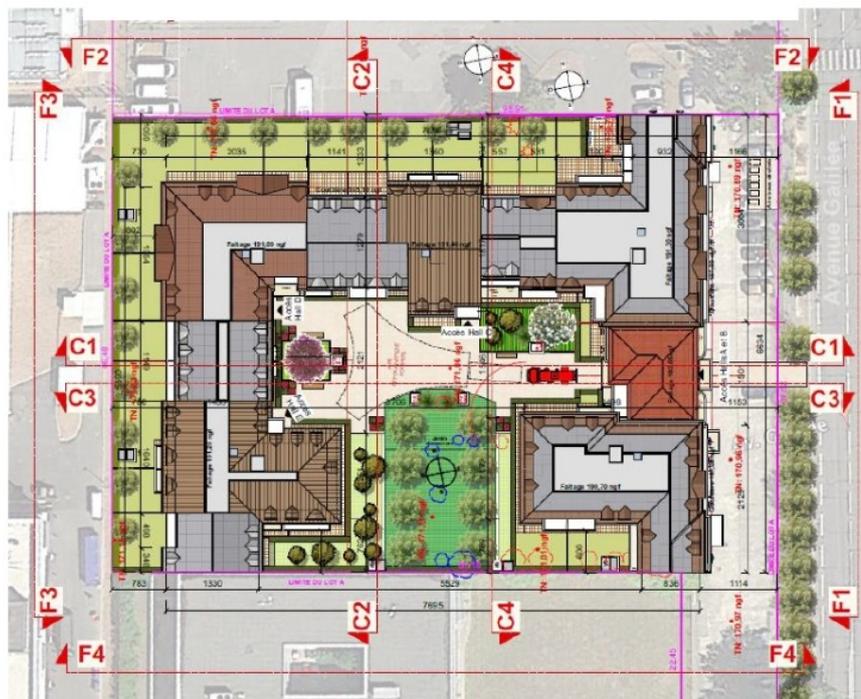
Plan masse du projet Galilée (source: étude d'impact, p.36)
